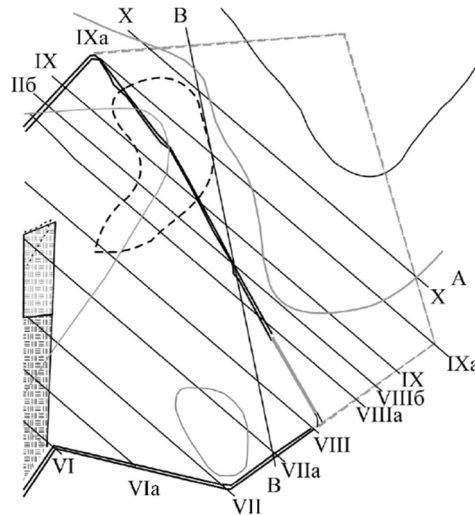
План горных работ карьера барита с расчетными профилями
